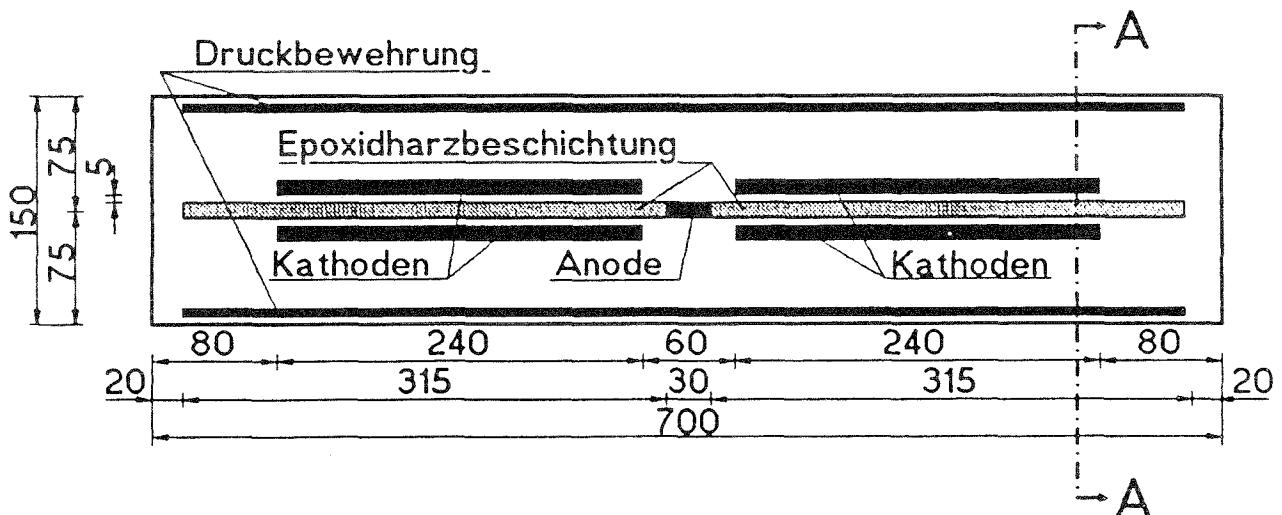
Bewehrungsanordnung; Balken LL11 - LL26
